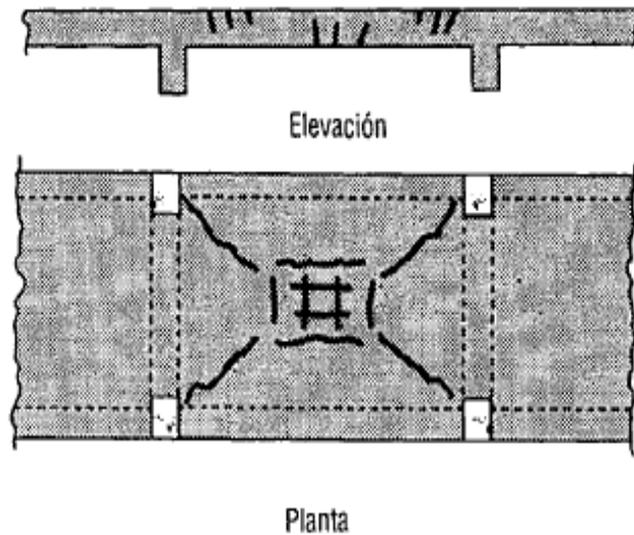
FISURAS DE FLEXIÓN
